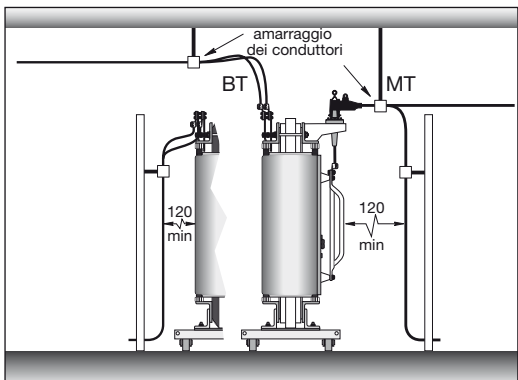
collegamento MT a mezzo di terminali sconnettibili.
